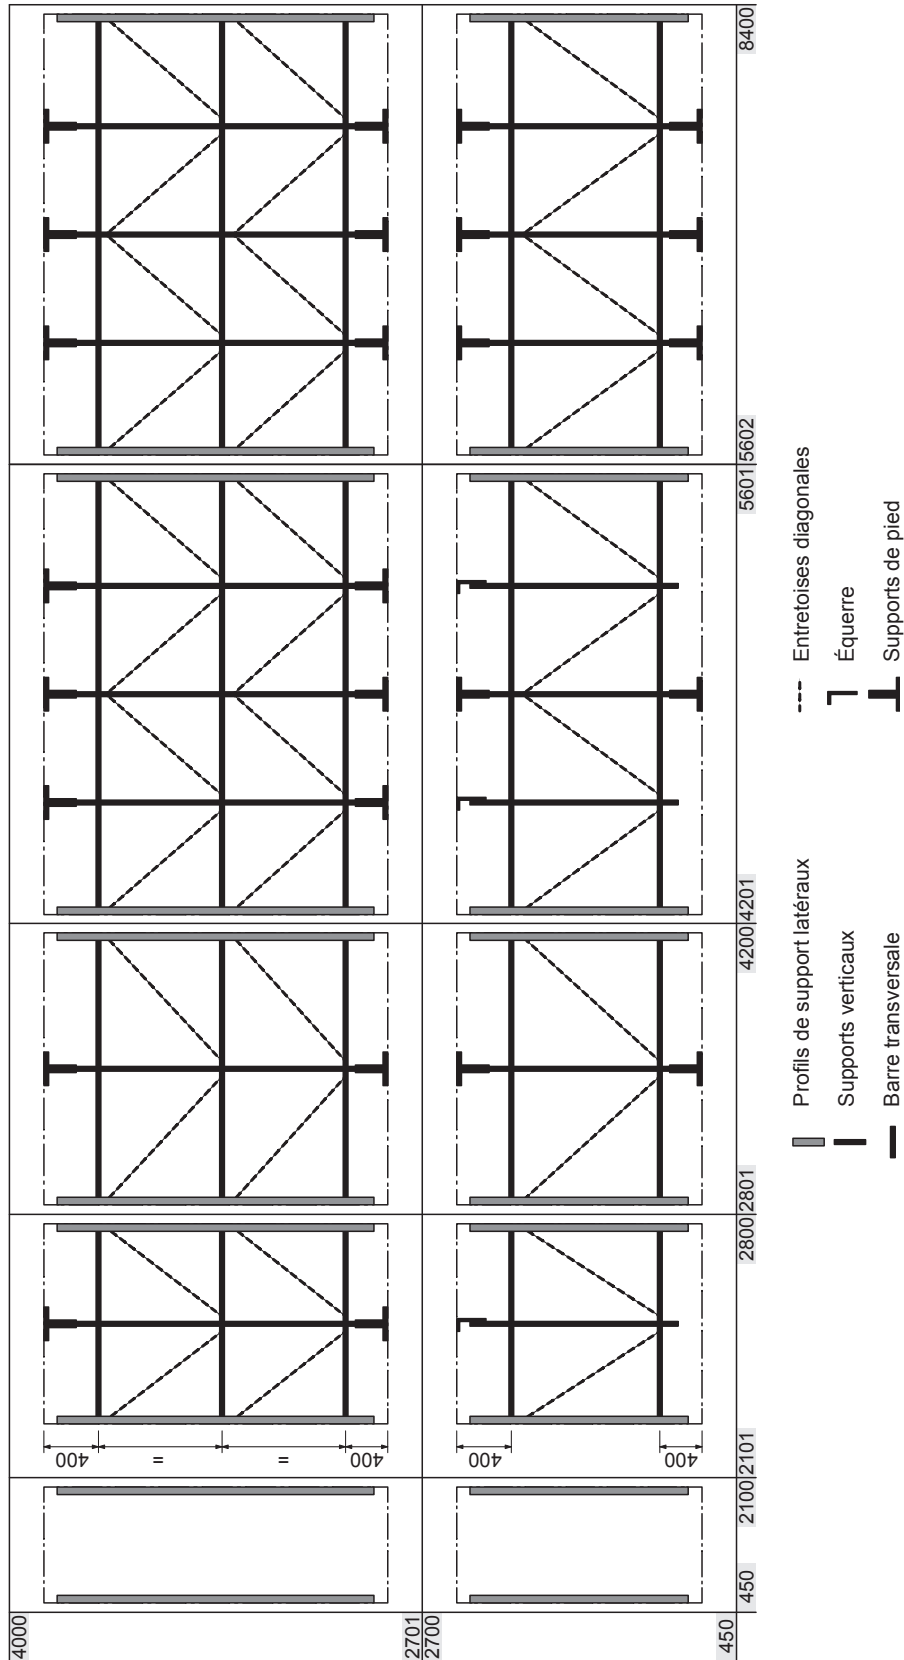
Aperçu des constructions-cadre de l'unité de posthumidification (dimensions de l'intérieur du conduit en mm)
